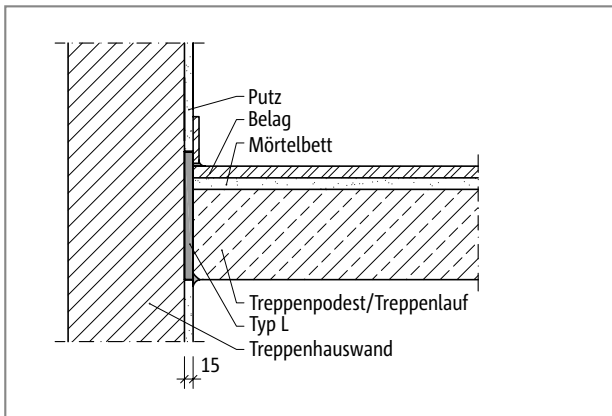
Schöck Tronsole® Typ L: Brandschutzausführung
